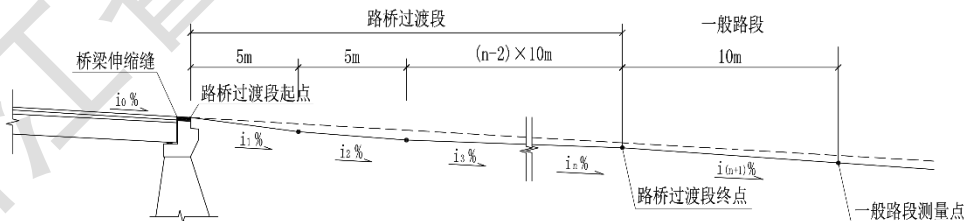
桥头不设搭板时纵坡测量断面示意图
